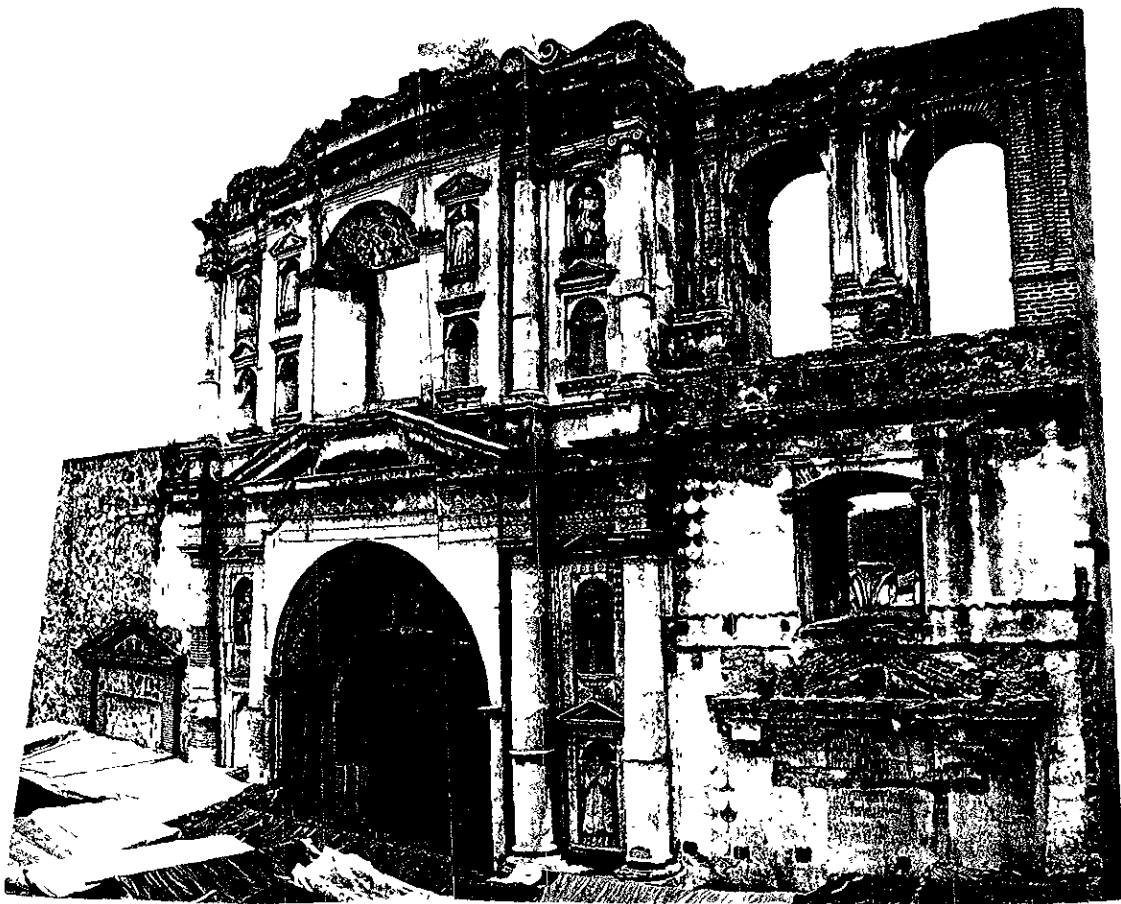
Estado actual de la fachada de la iglesia del Colegio San Lucas. Feb. 1997
